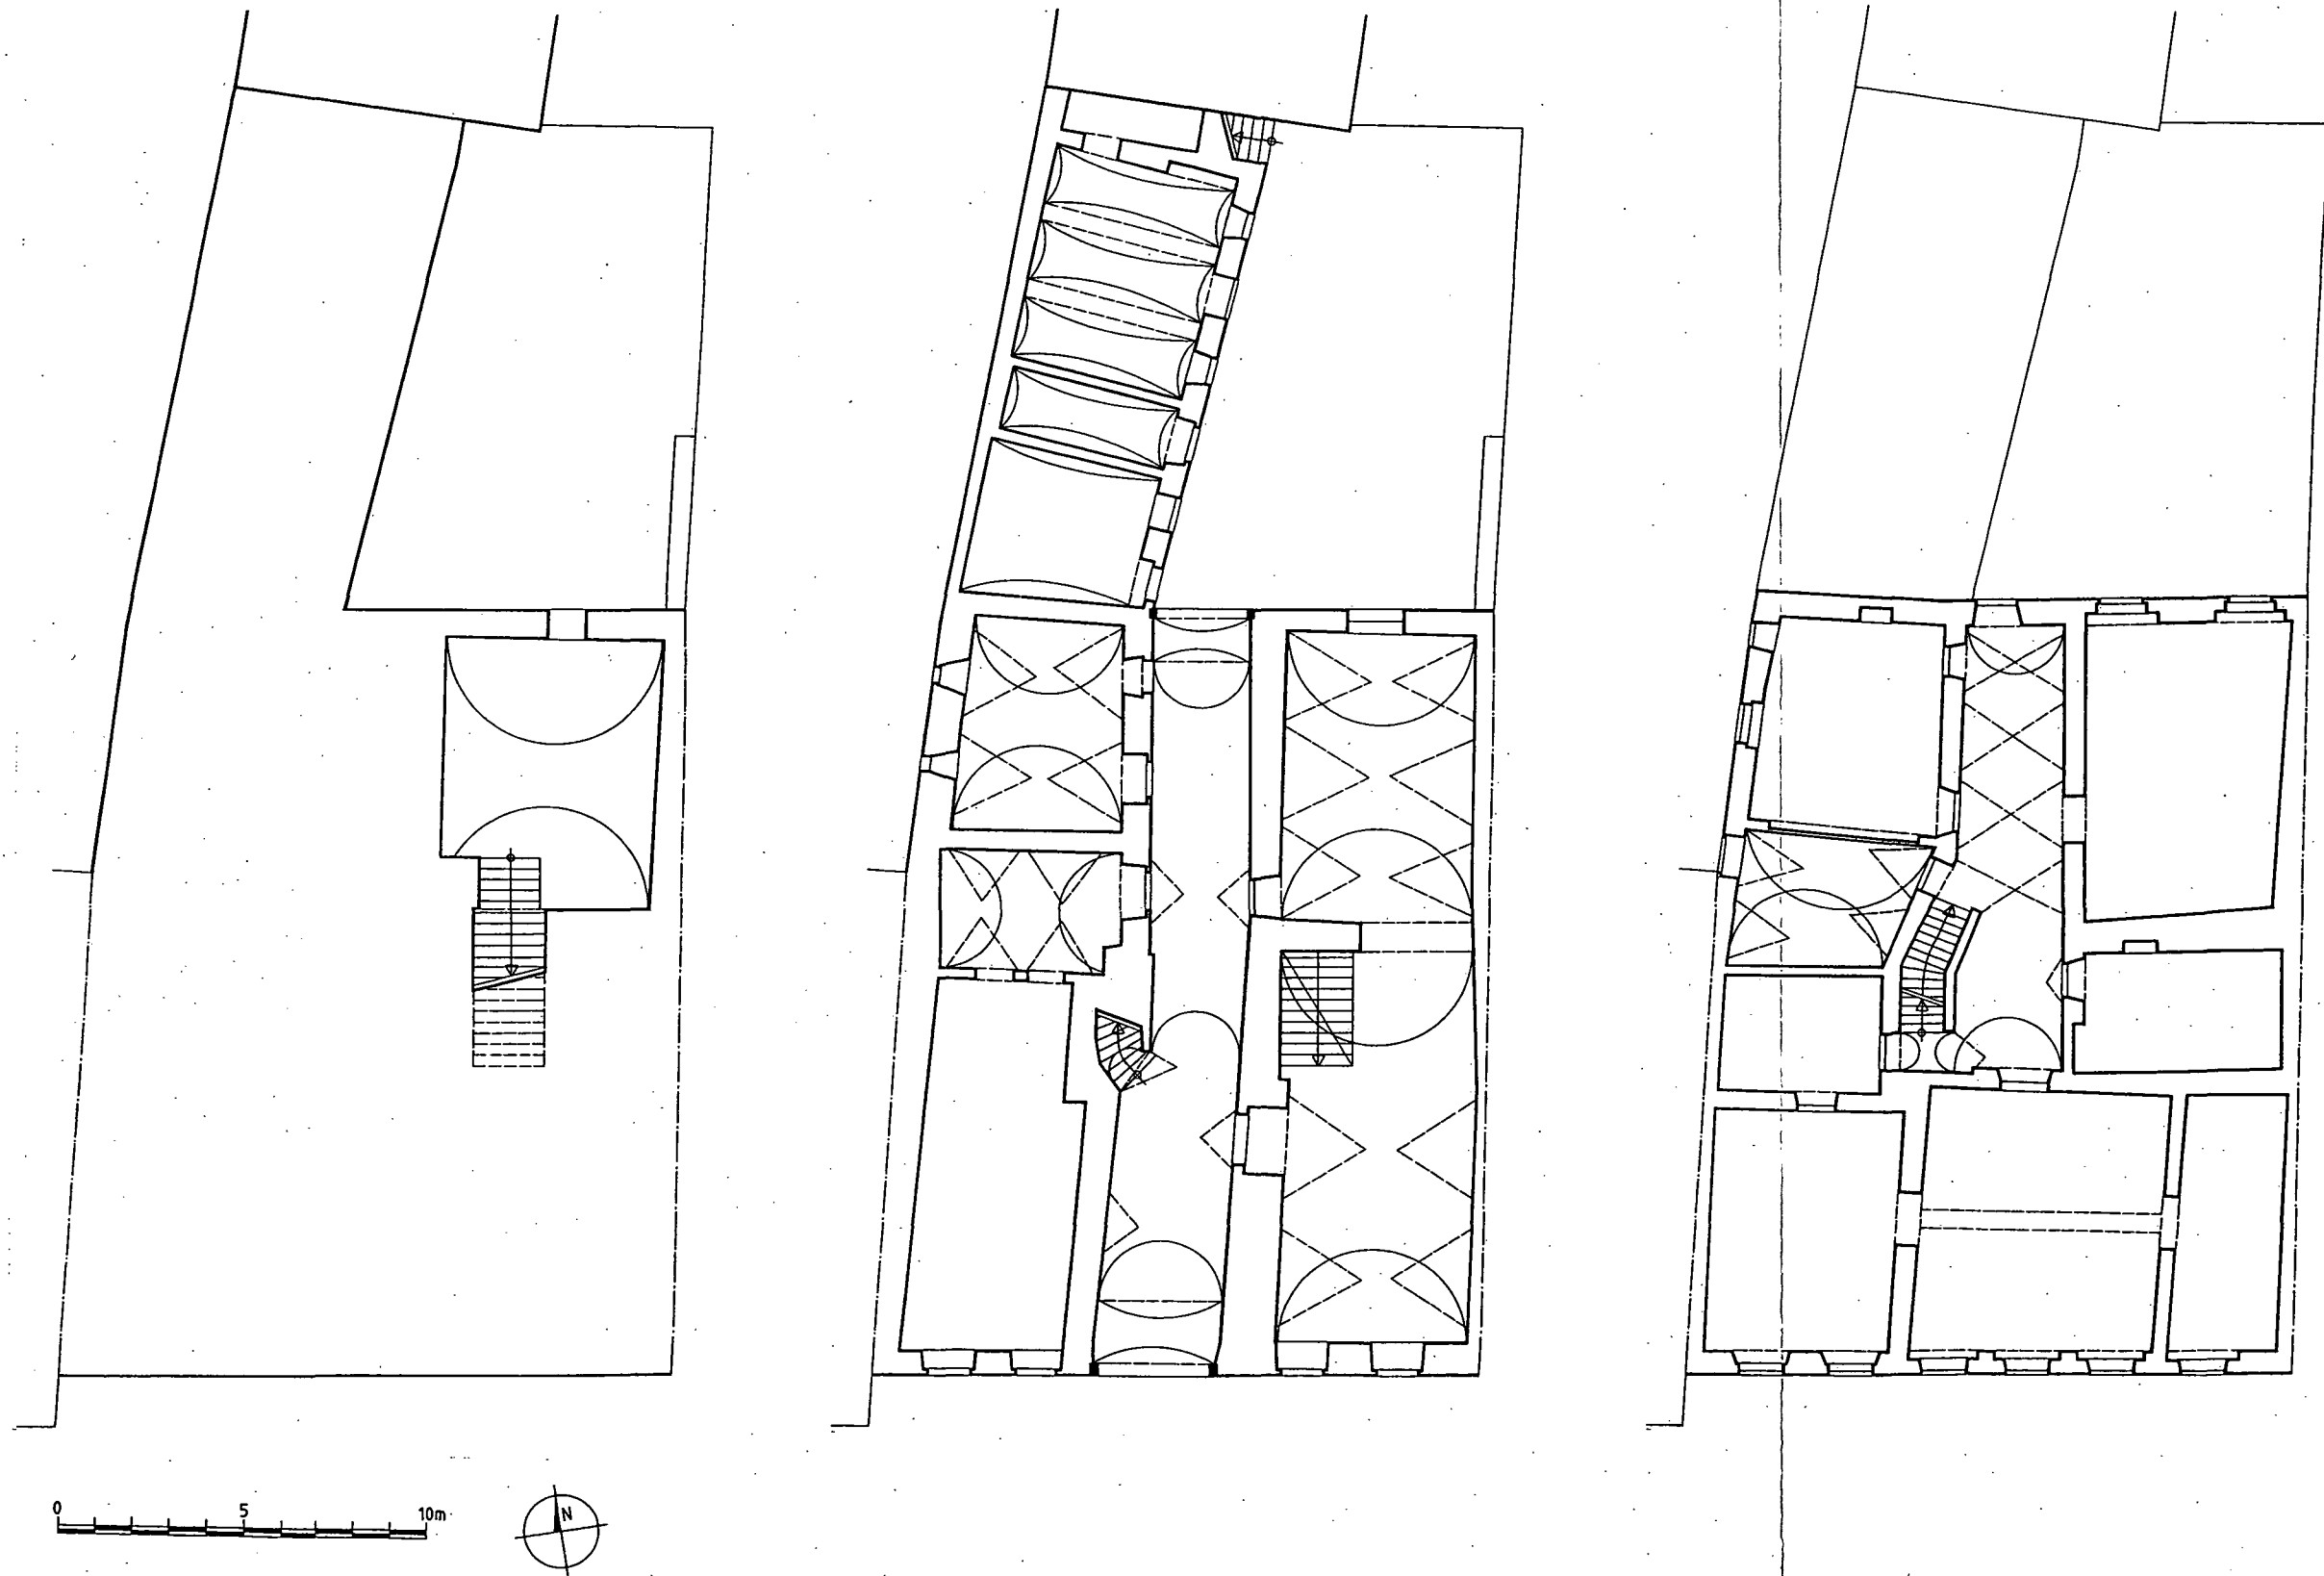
Schmiedstraße 20 – Grundrisse Keller, Erdgeschoss, Obergeschoss (1:200).
